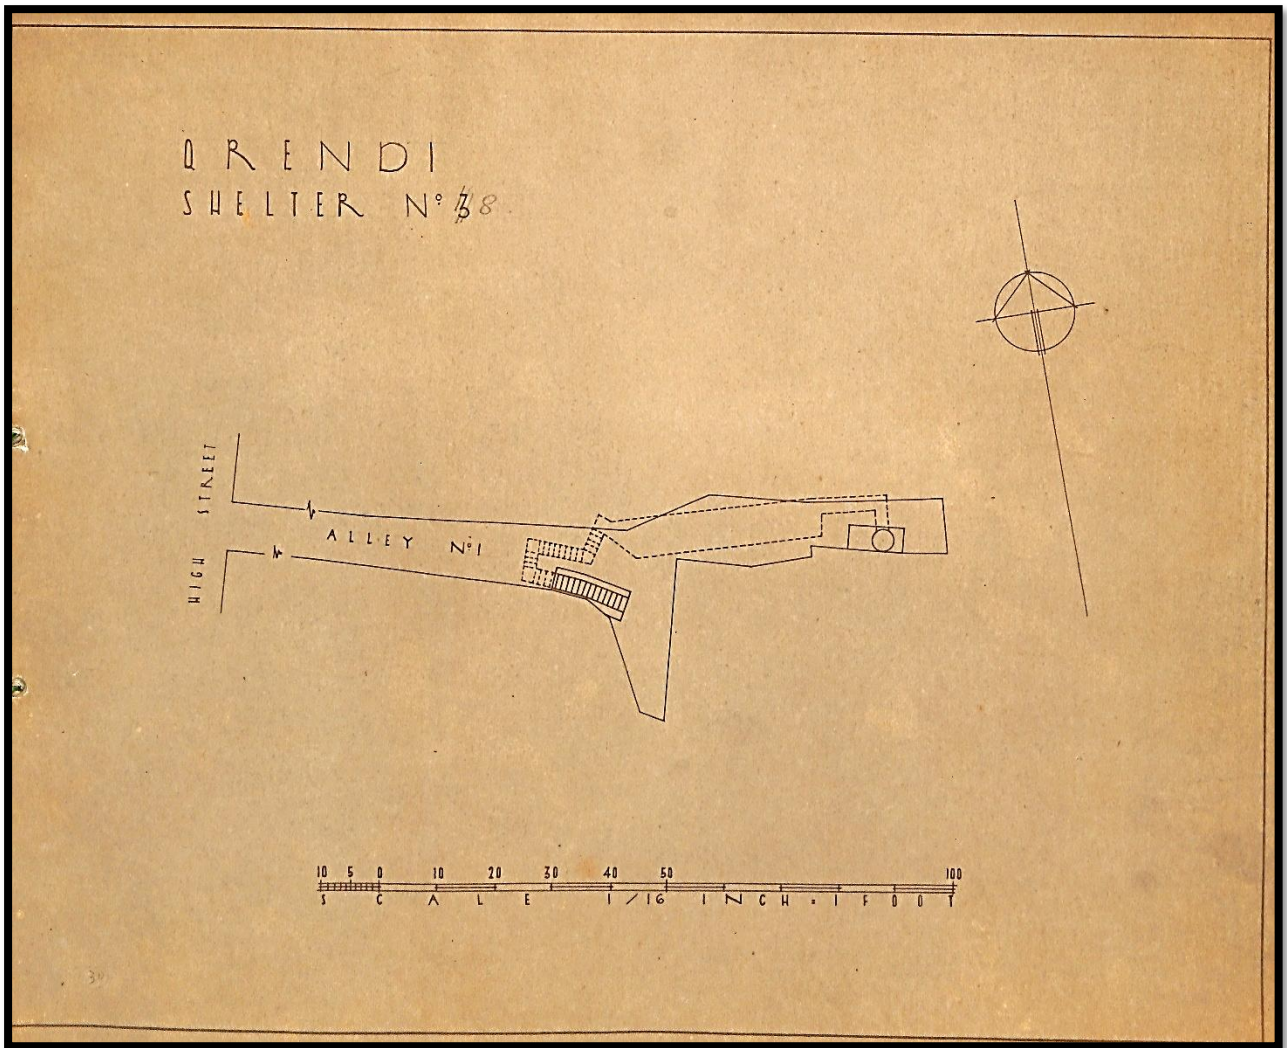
Planta do Abrigo nº8 "High Street – Alley nº1."
